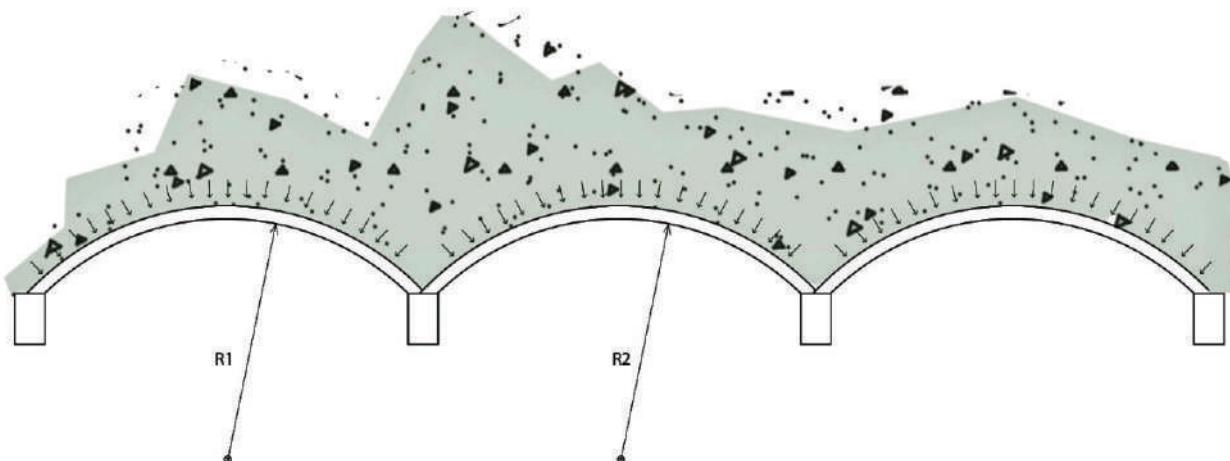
Planta Baixa. Os raios podem ser diferentes, segundo o projeto. (*-5).
